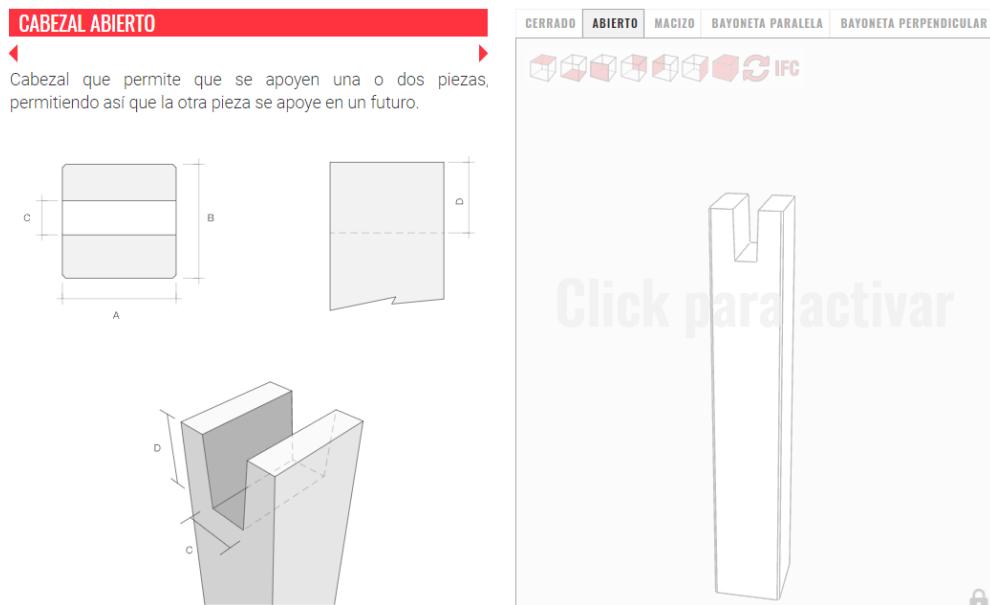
Extremo del pilar adaptado para aceptar la unión con la viga B-36 [13]
